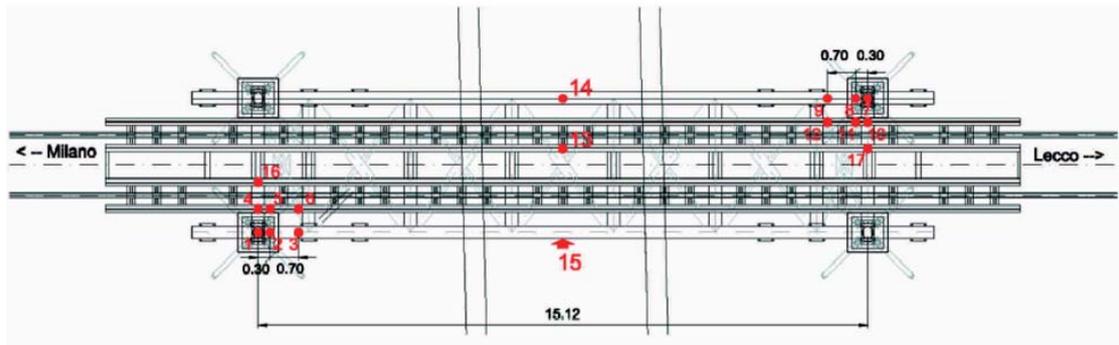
Disposizione planimetrica dei trasduttori di spostamento.
